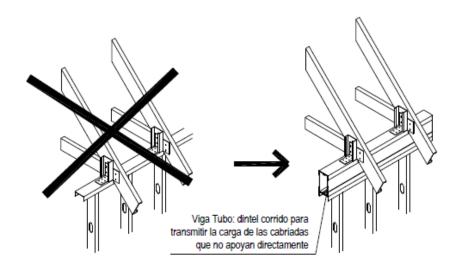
Estructura de cubierta no modulada y corrección con estructura de apoyo.
